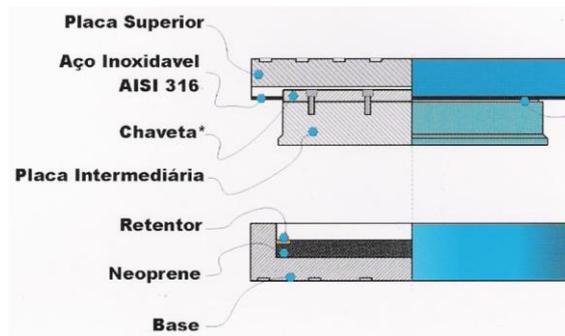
Aparelho de apoio metálico à base de politetrafluoretileno.
